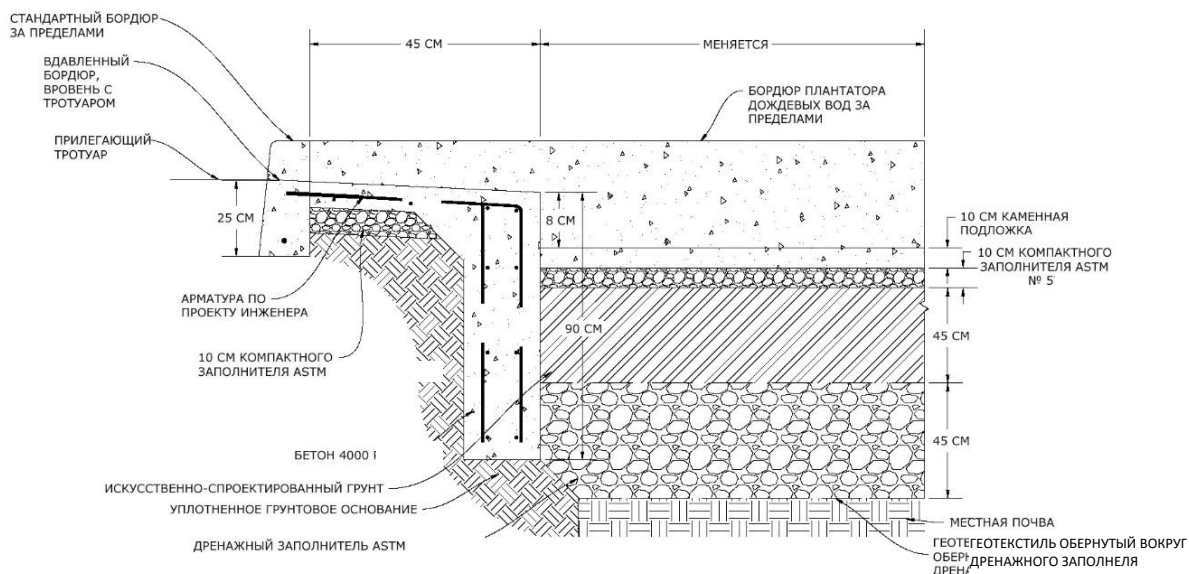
Типовой профиль плантатора при обрезке бордюра
